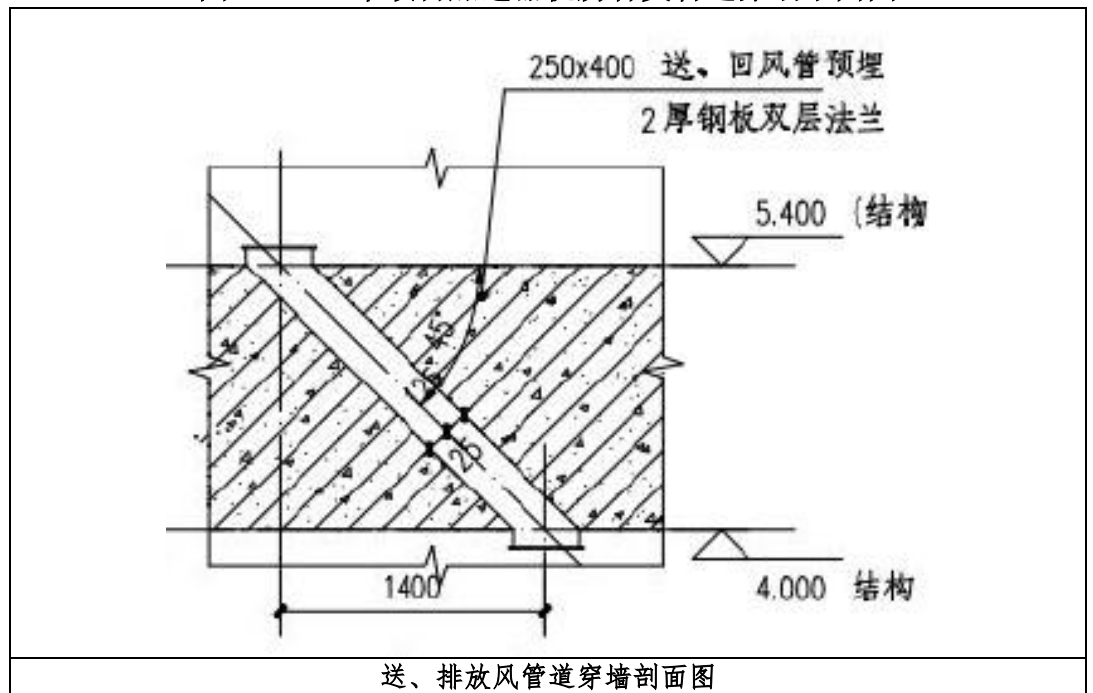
本项目加速器机房各类管道穿墙平面图
